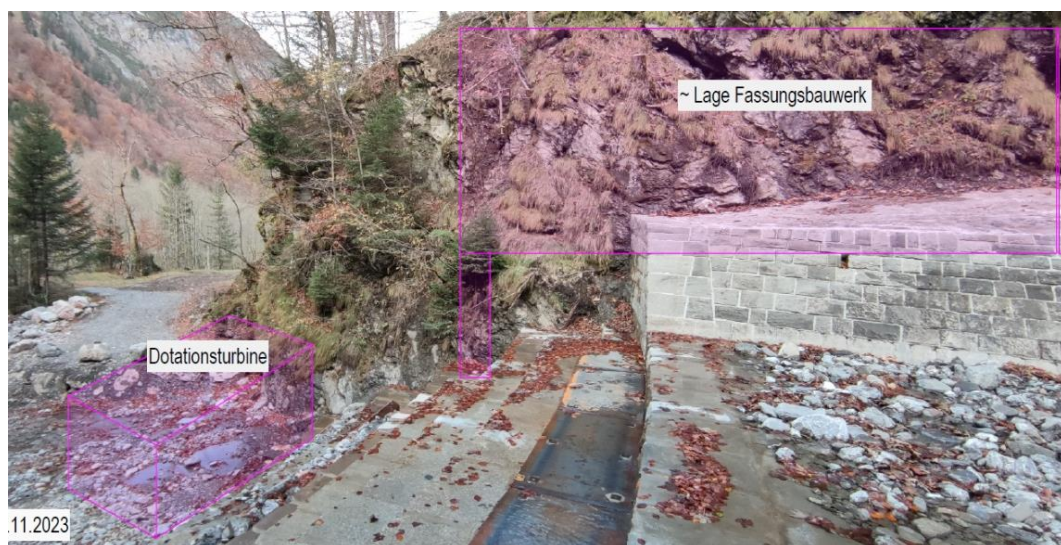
bestehende Sperre – Standort geplantes Fassungsbauwerk
